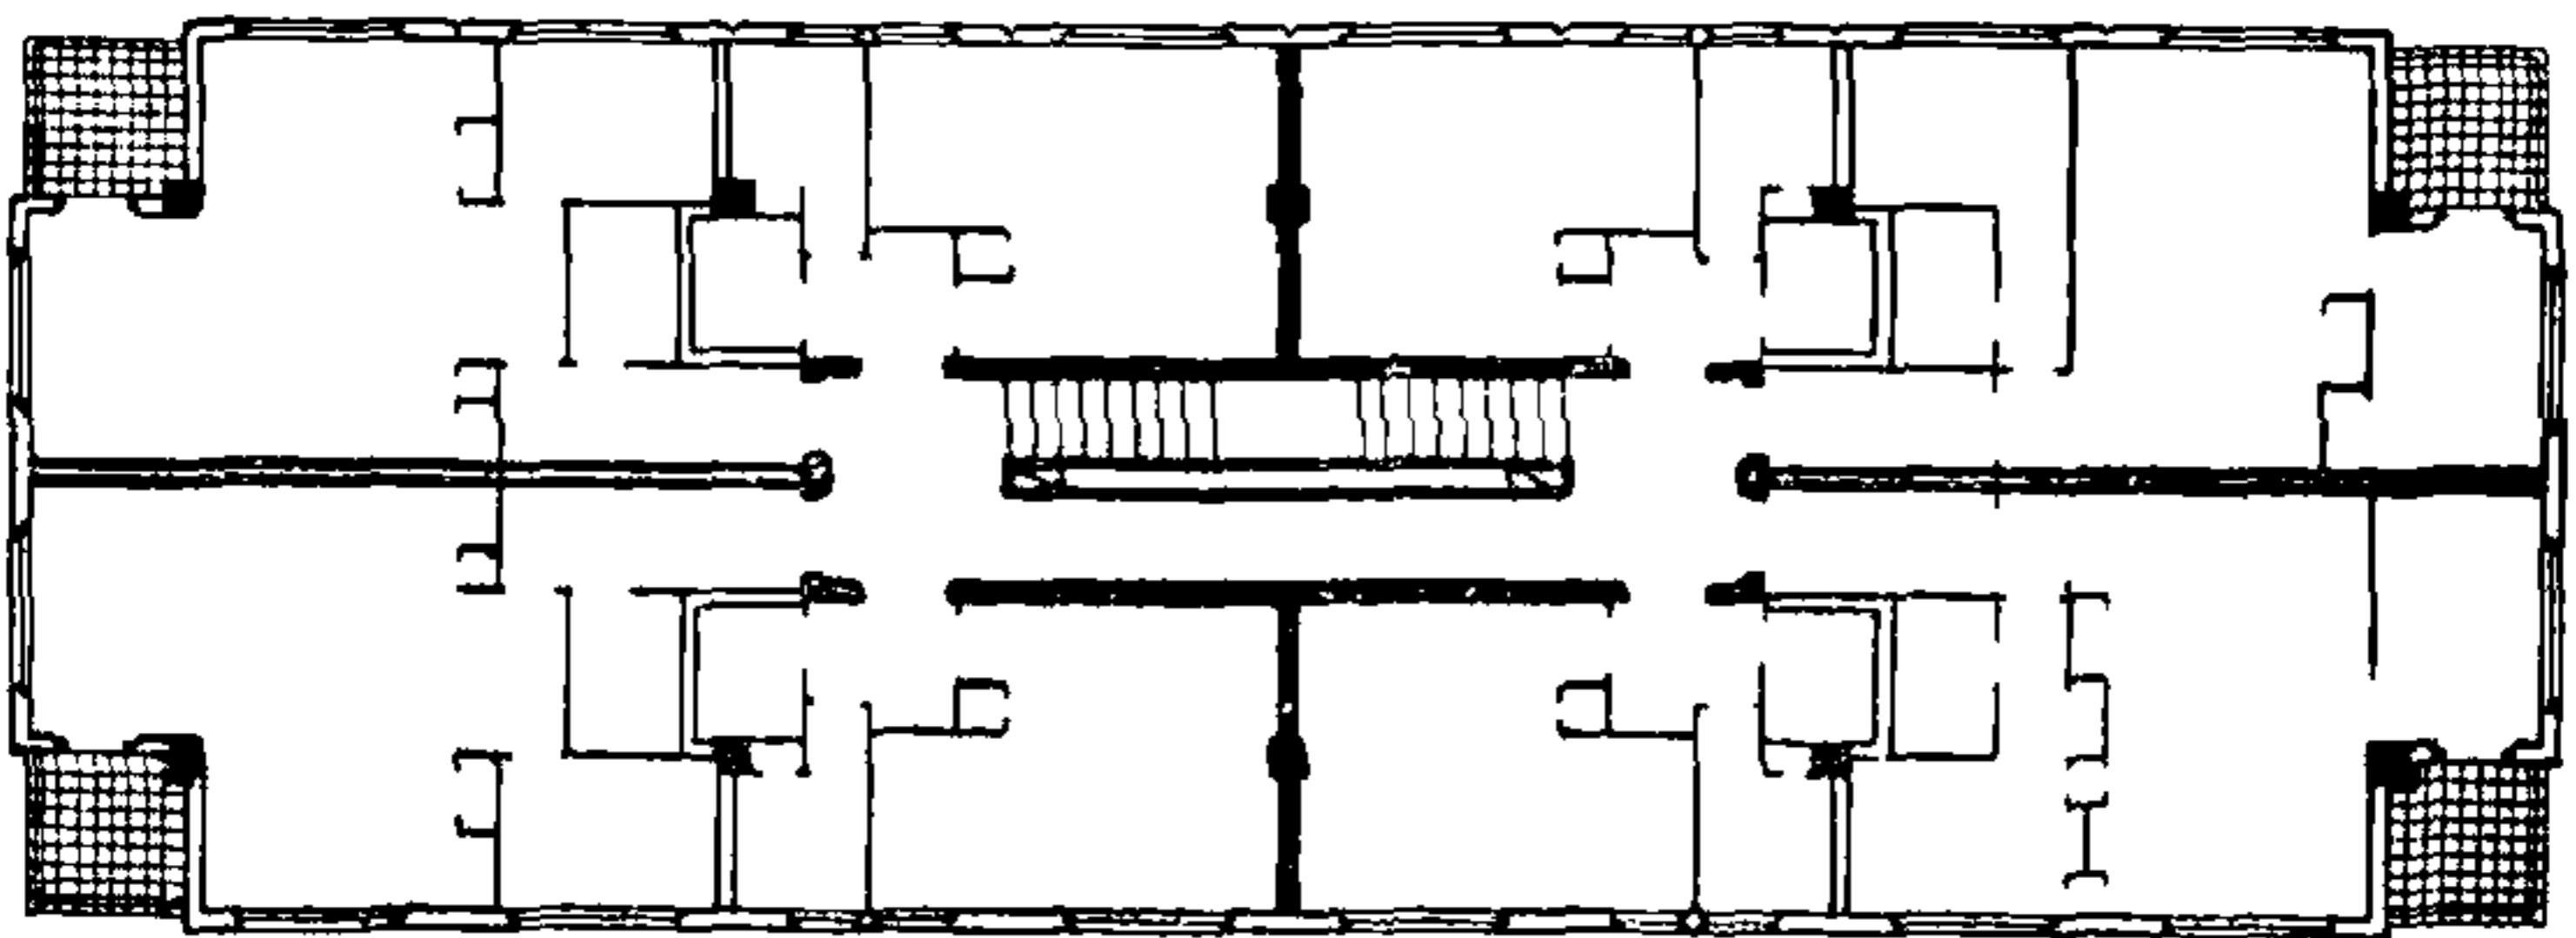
План типового этажа 4-этажного жилого дома, построенного методом подъема этажей (ЛенЗНИИЭП)
